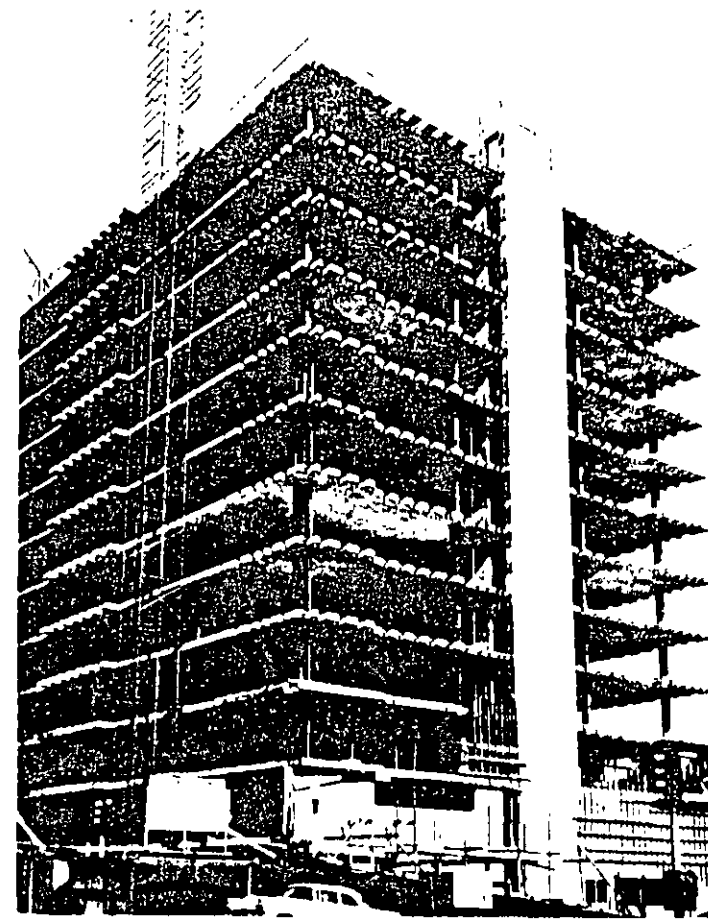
Construcción por izamiento de losas de un edificio de 13 pisos, en que las losas de hormigón postensado se apoyan en columnas de acero y en torres de hormigón hechas con formaleta deslizante.
